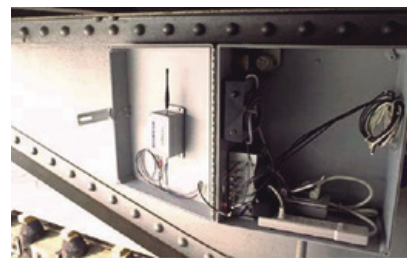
Detalhes da instrumentação e fissuras ocorridas na estrutura
